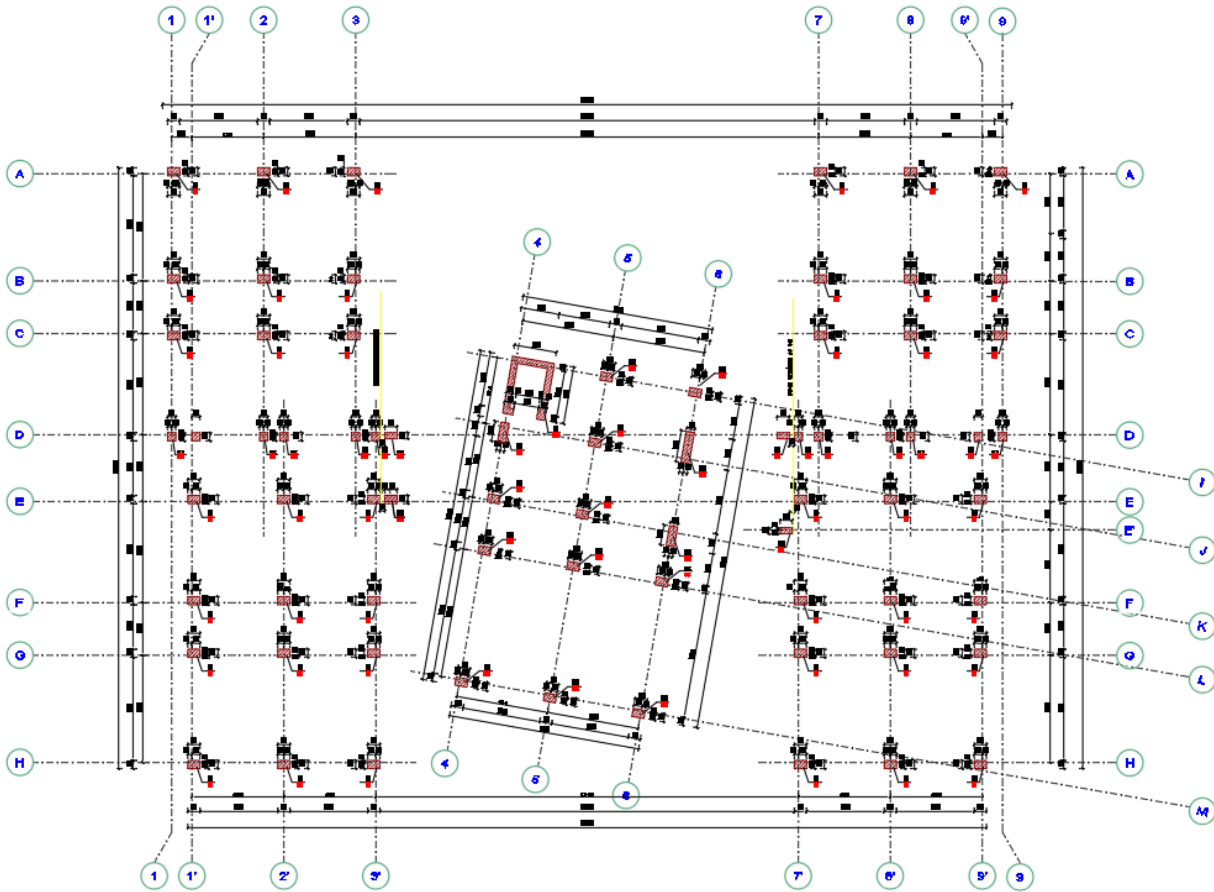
Plani i piketimit te kollonave, Kuota (+6.25)
